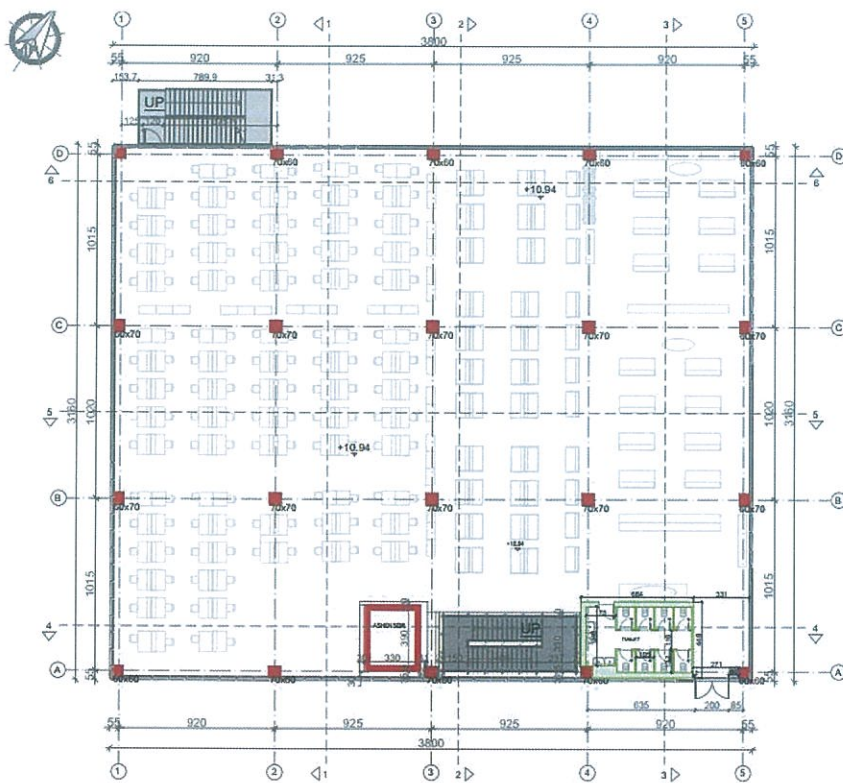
Planimetria e katit të dytë, kuota + 10.94
